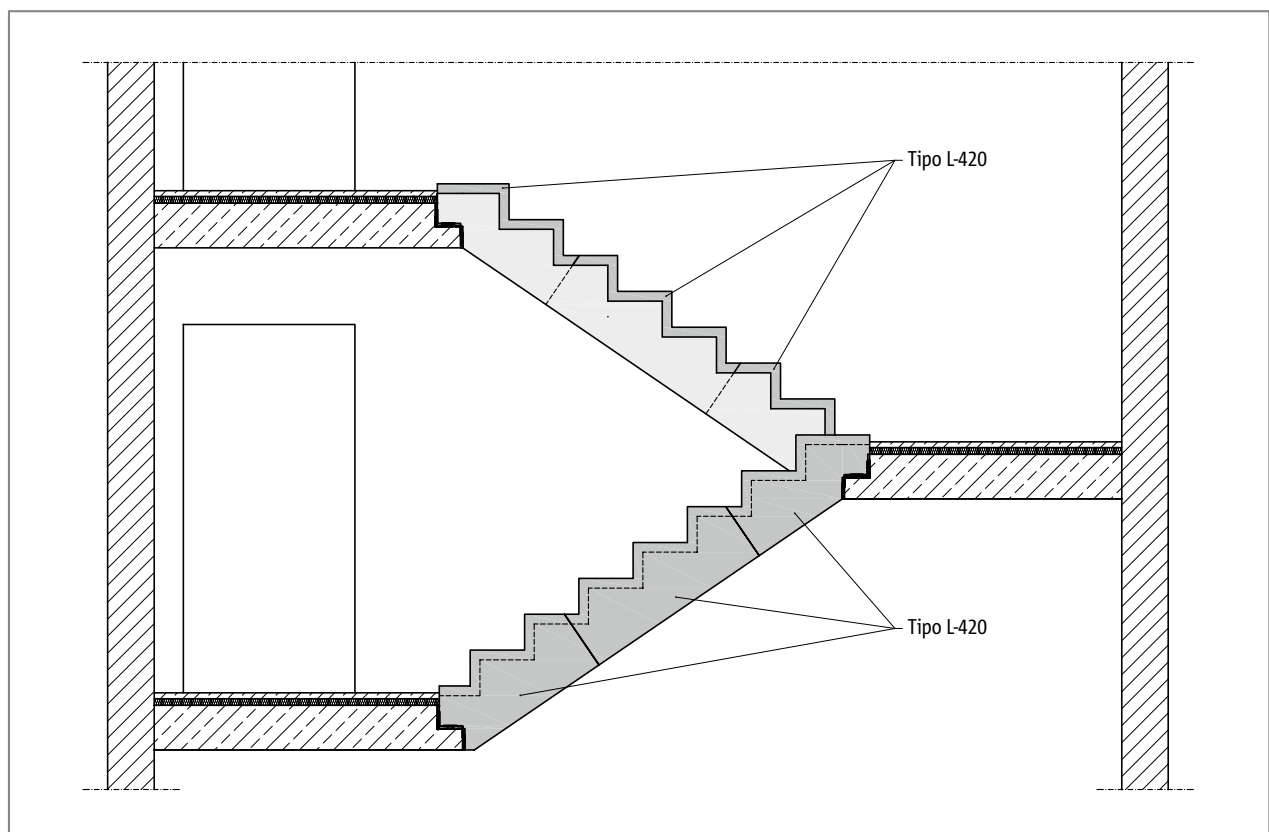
Schöck Tronsole® tipo L-420, disposizione dell'elemento; sezione A-A
